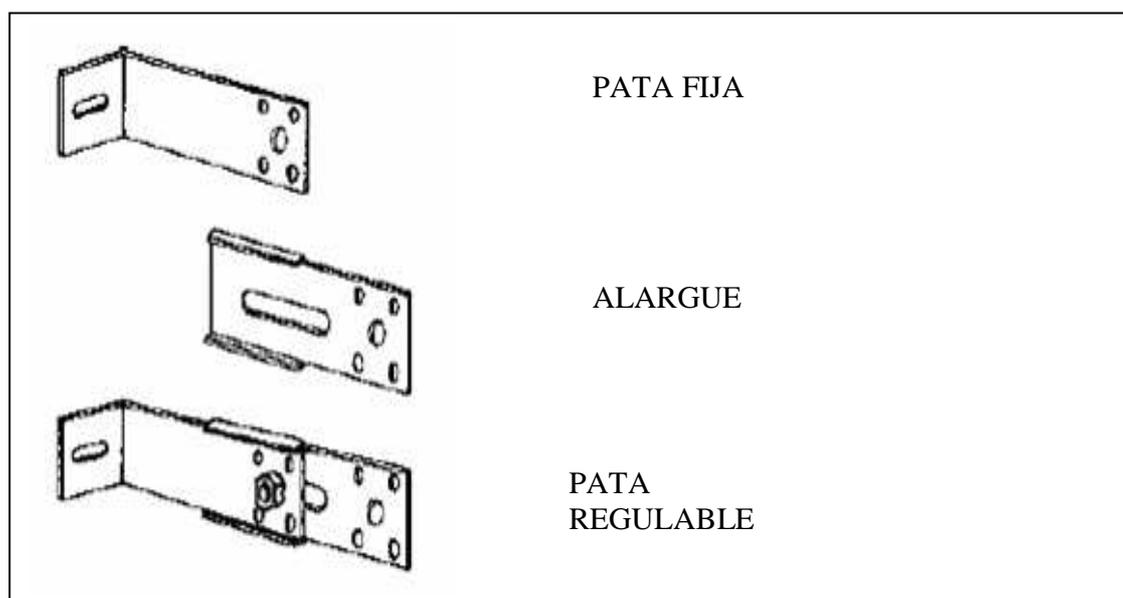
Tipo de fijación de estructura a muro soportante
